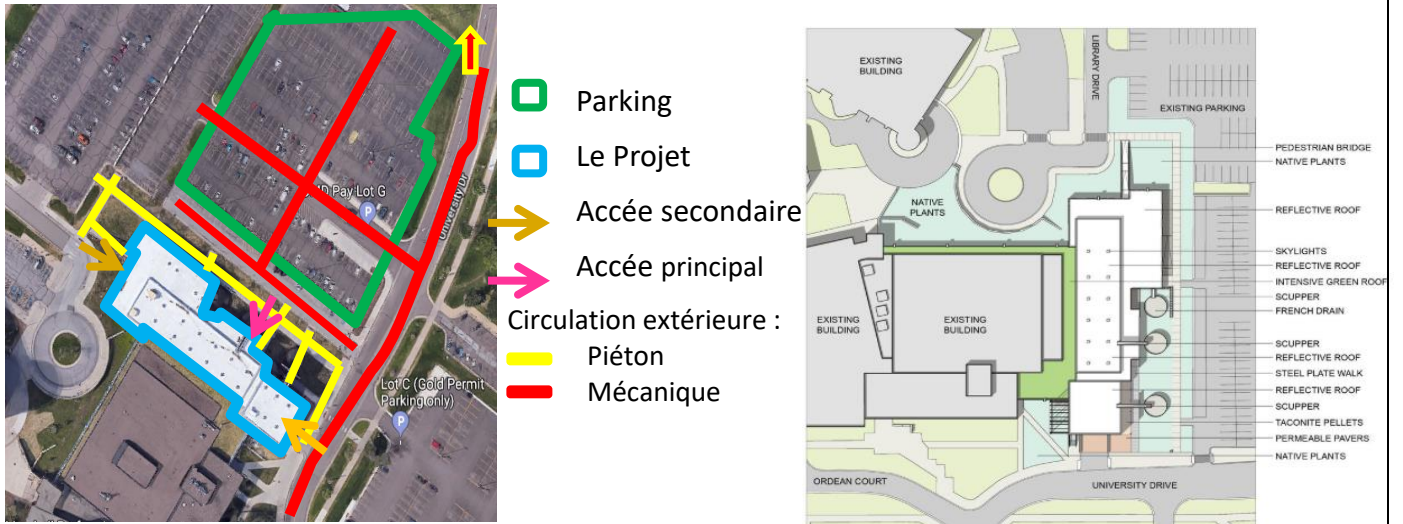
Schéma du plan de masse de Swenson Civil Engineering Building
